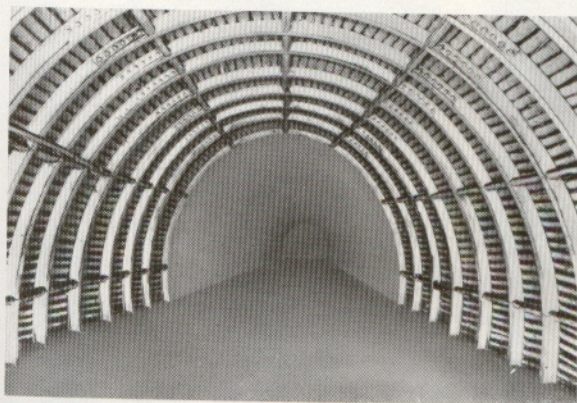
Stollen-Schutzraum mit Stahl-Ausbaubögen teilweise bereits ausbetoniert.
